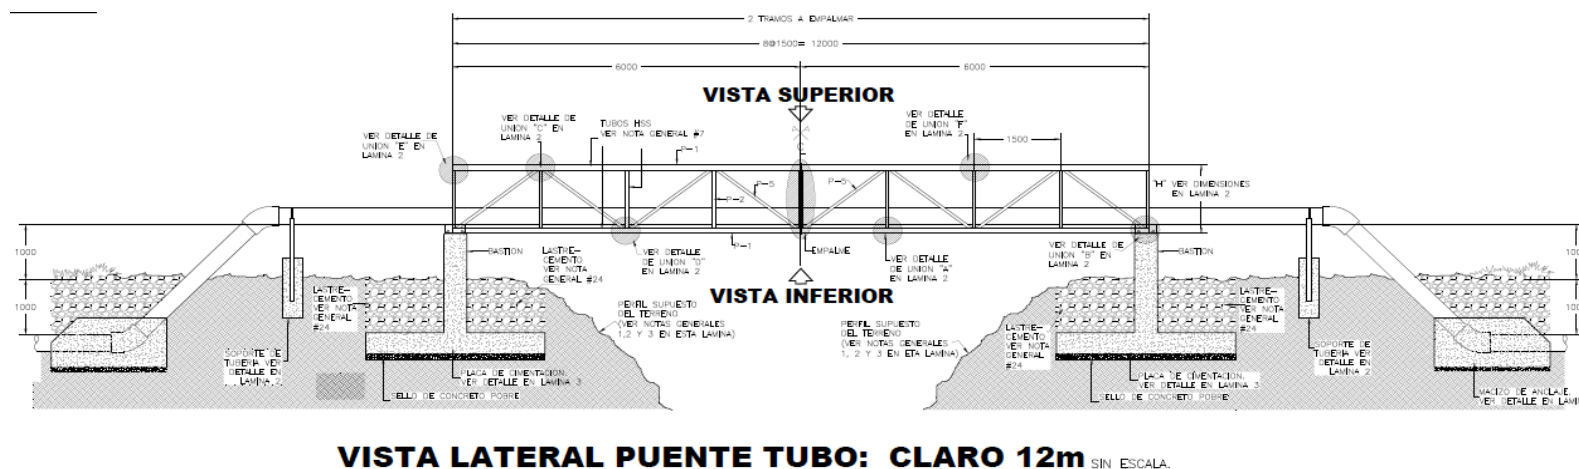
Diseño tipo de un puente elevado tipo tubo para tubería de agua potable. Fuente. Planos brindados por el AyA, 2018.
